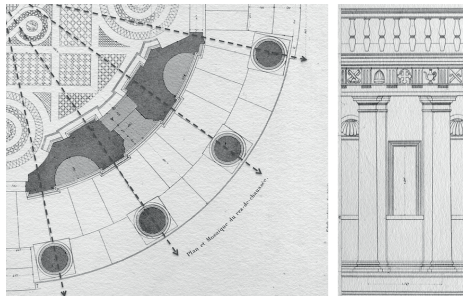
Rayonnement des pilastres et des colonnes du Tempietto en plan et élévation (d'après Paul Letarouilly)
